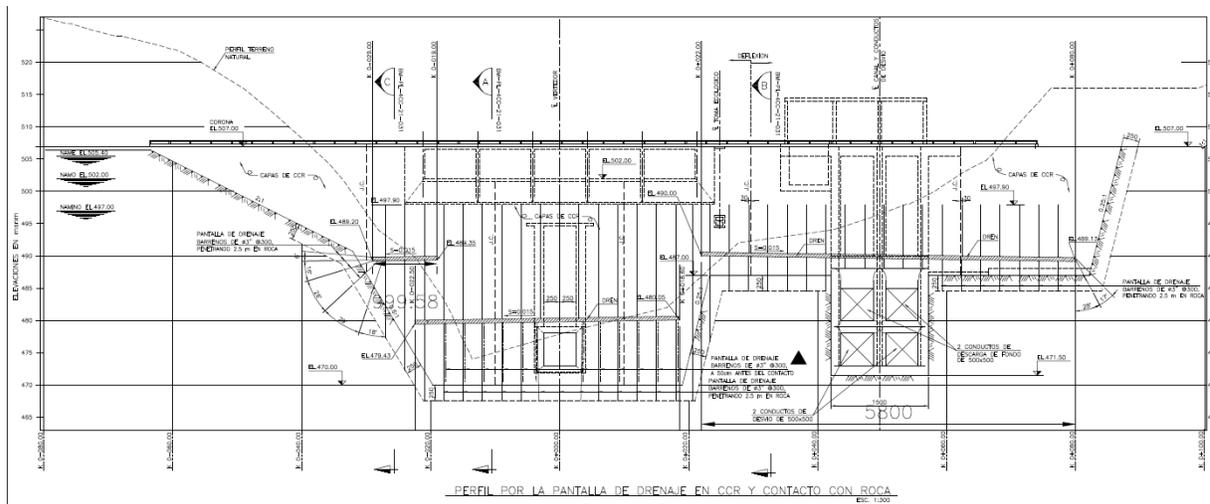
Sección de perfil de la presa Bajo de Mina
